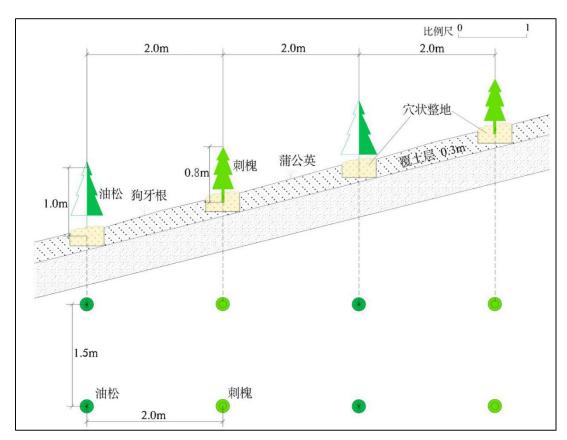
废石场复垦单元复垦工程设计立面图、平面图 表 5-9 废石场单元植被种植规格表
